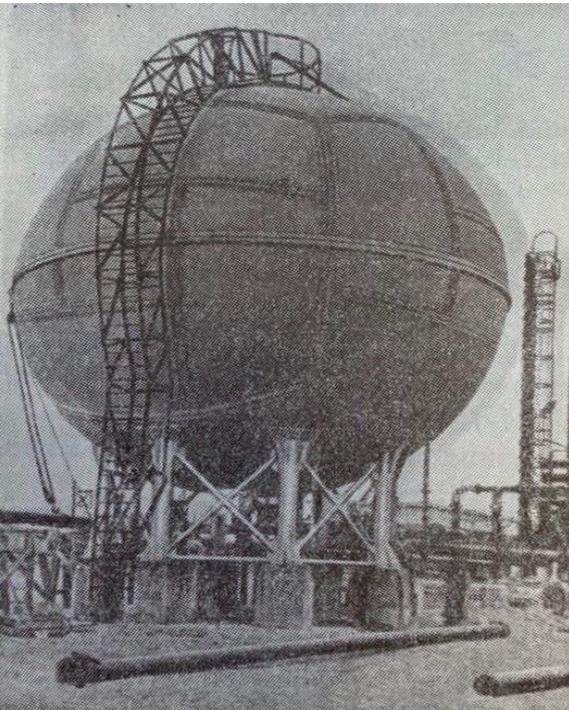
Клепанный шаровой резервуар с катучей лестницей
